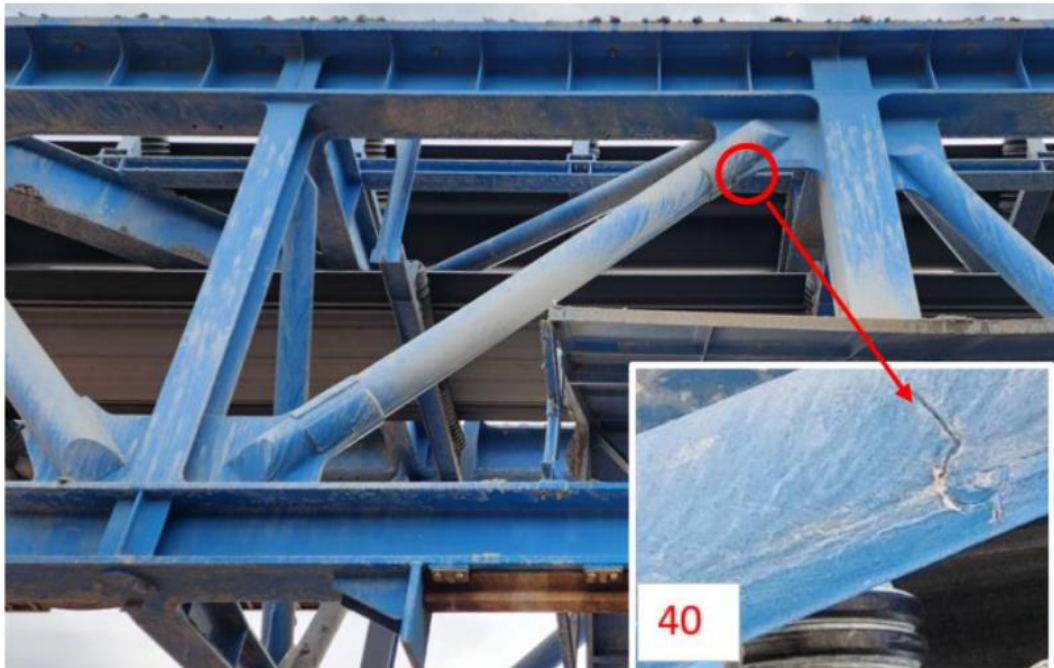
Grietas típicas detectadas en arriostramientos verticales tubulares.
